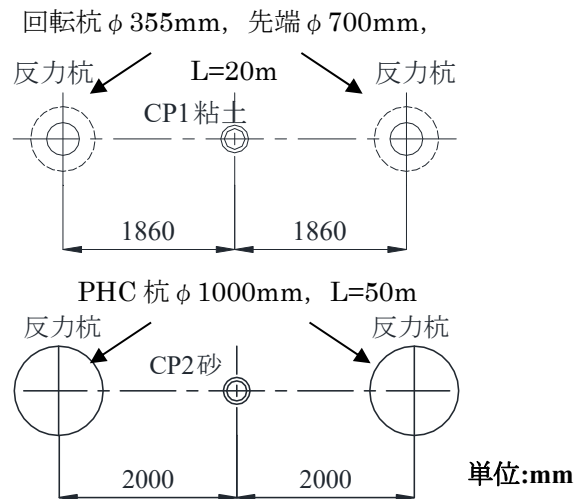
試験杭と反力杭の配置（引抜き载荷試験）
